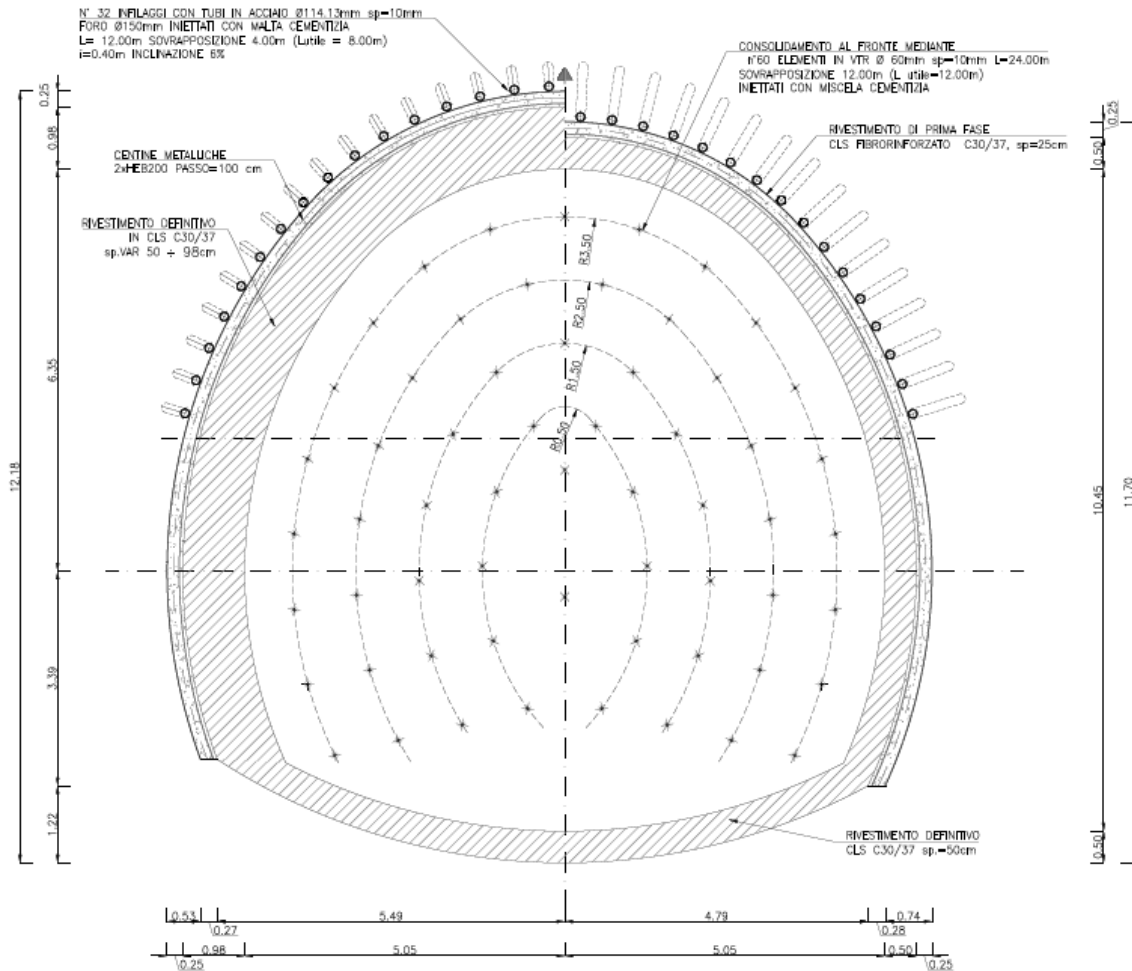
Sezione tipo SGC-lmb: geometria del cavo e interventi di sostegno, sezione trasversale
